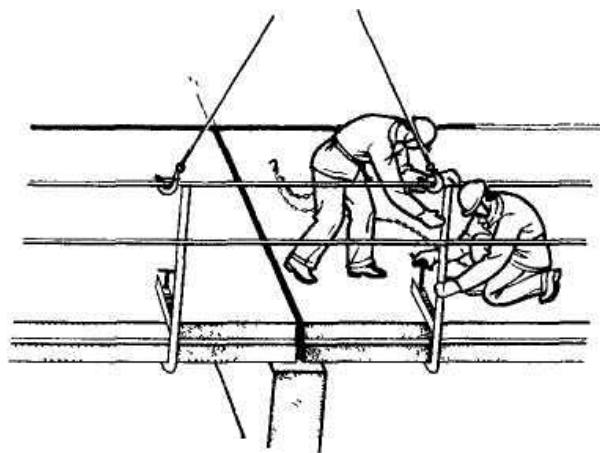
Укладання і анкерівка плити перекриття.
